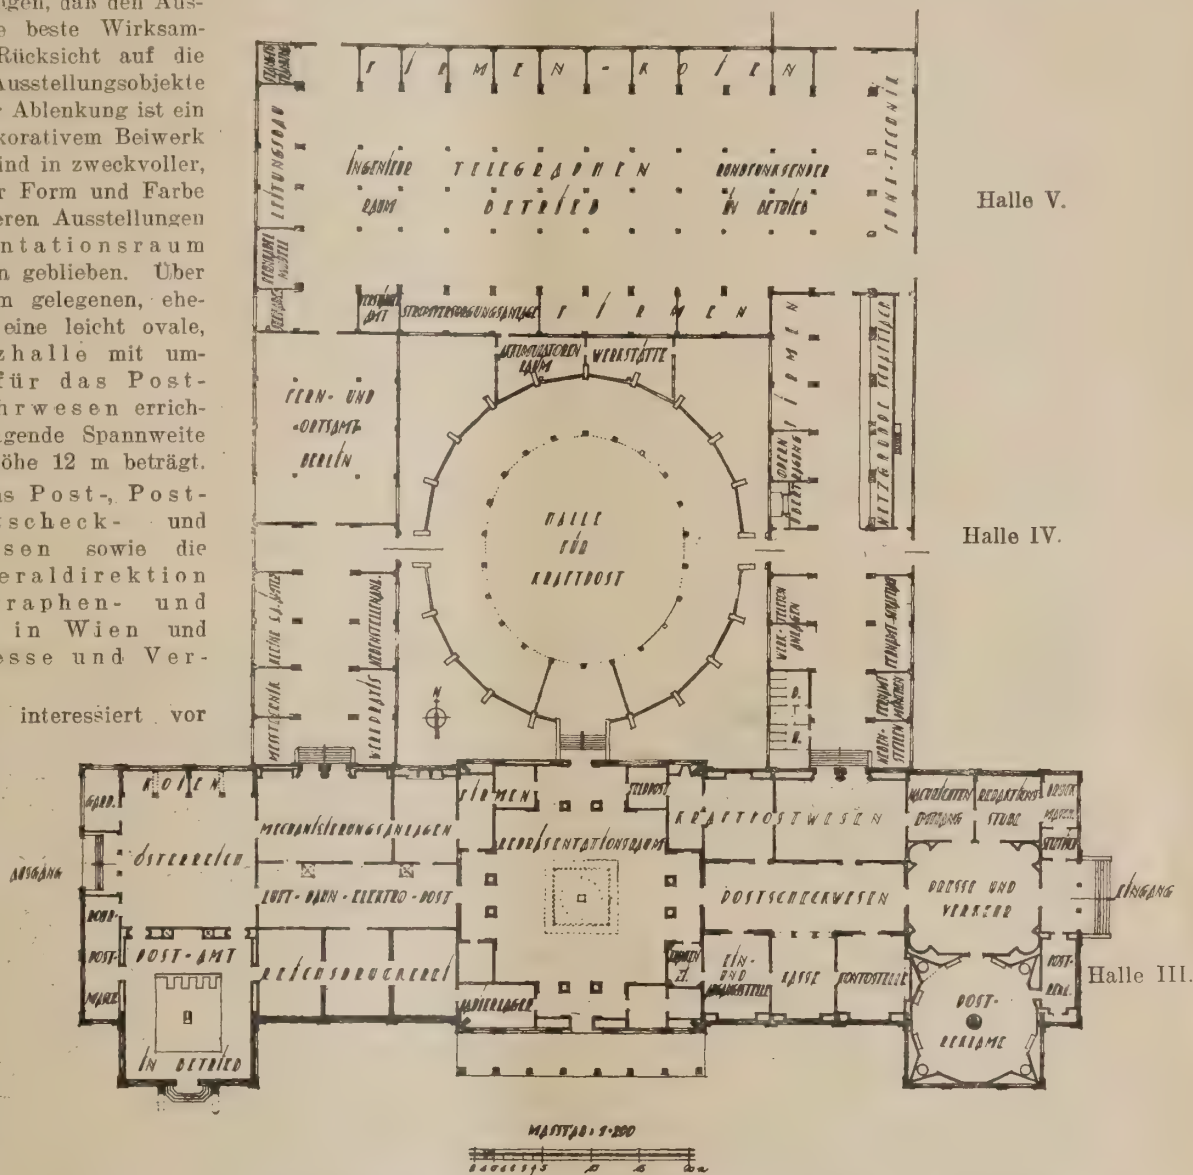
Lageplan d. Ausstellung des Postwesens in Halle III, IV u. V d. Deutsch. Verkehrsausstellung 1925
